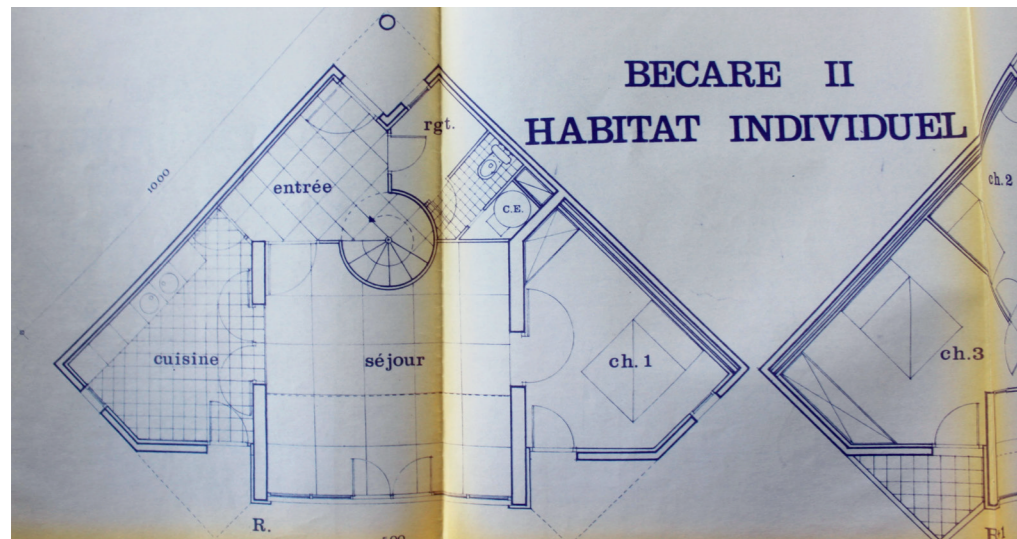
Plan d'une maison extrait du permis de construire, AM Angoulême.
